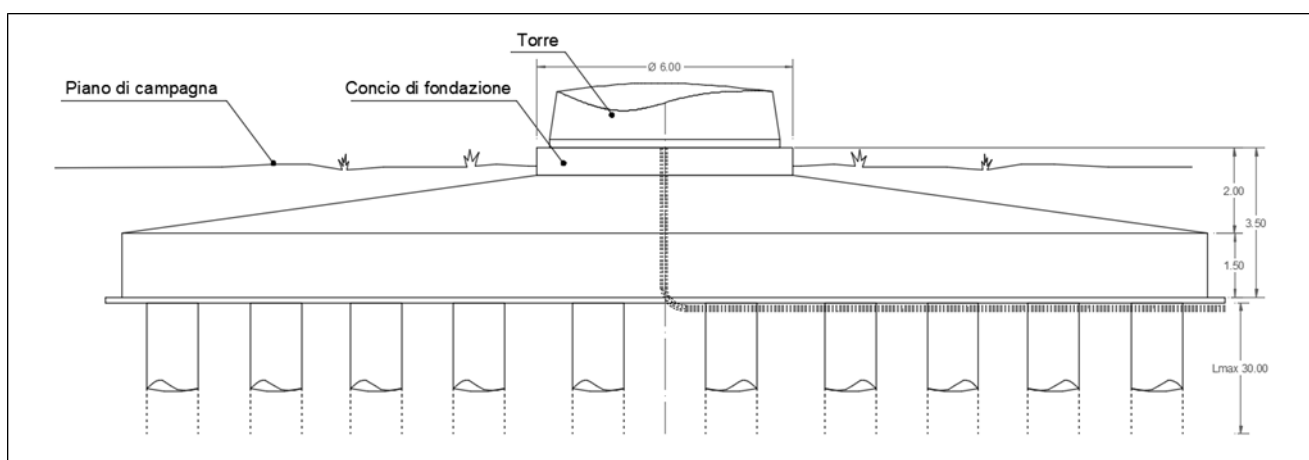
Piazzola di montaggio e sezione di posa plinto di fondazione.
